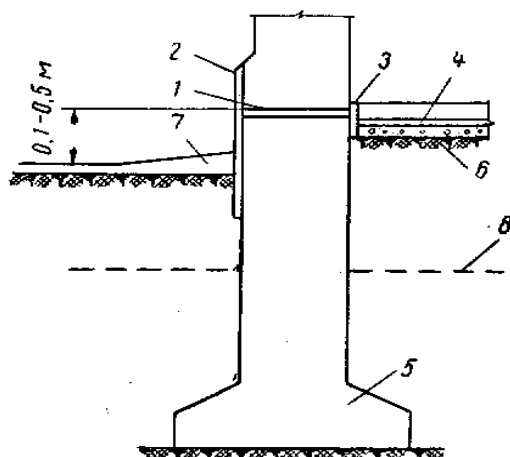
Устройство противокapиллярных прокладок в стенах.
